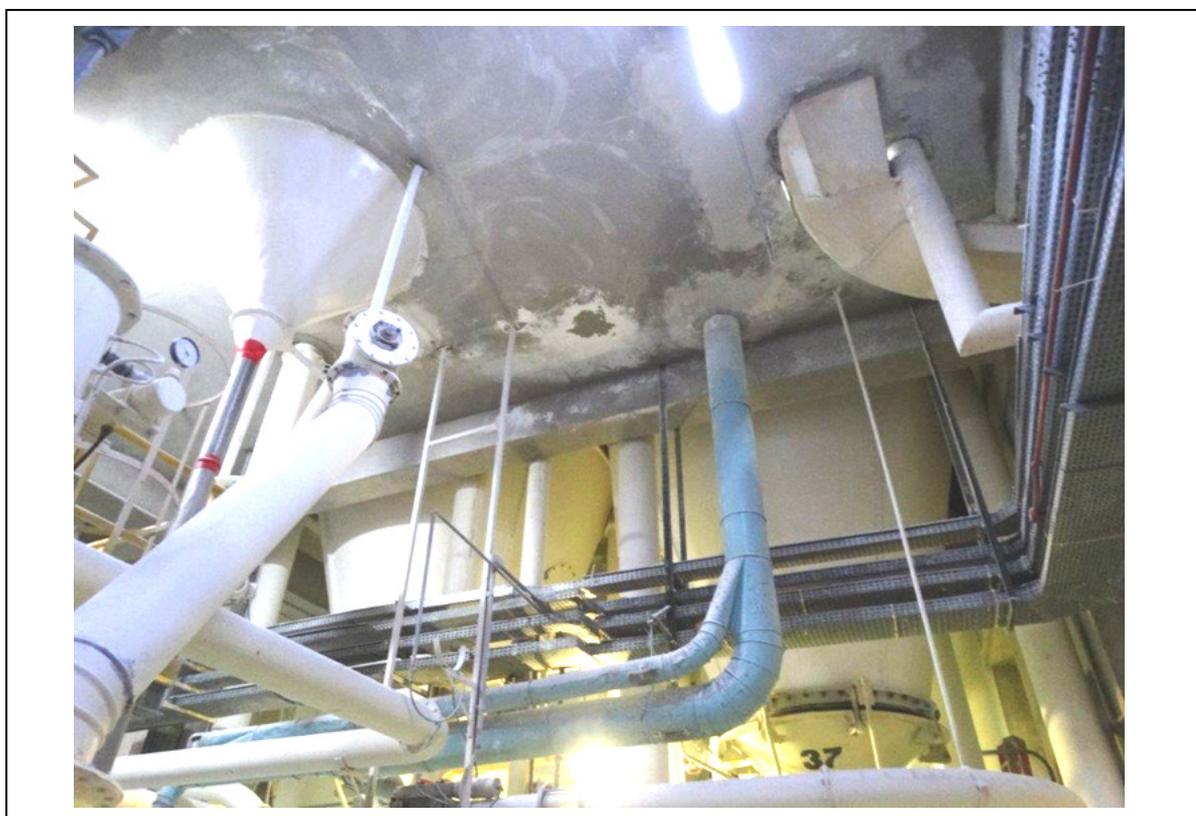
PRÉDIO H1: 1º ANDAR.
